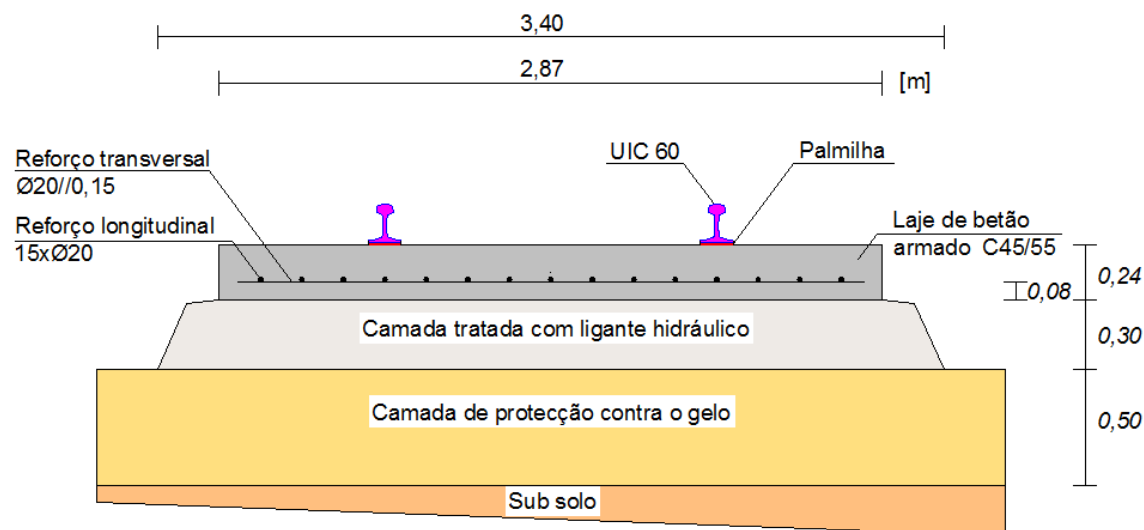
Perfil transversal esquemático da via em laje com armadura ordinária inferior (Marques, J. 2013)
